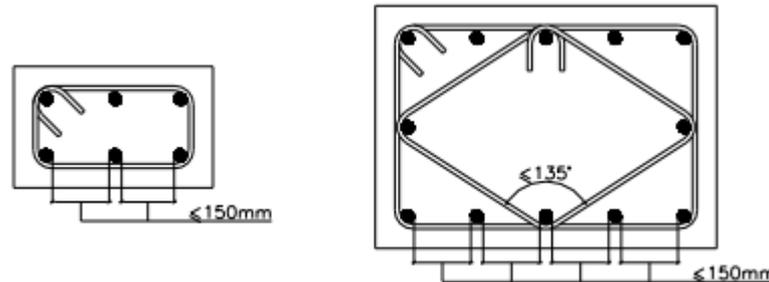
Separación máxima de barras sin apoyo lateral.
